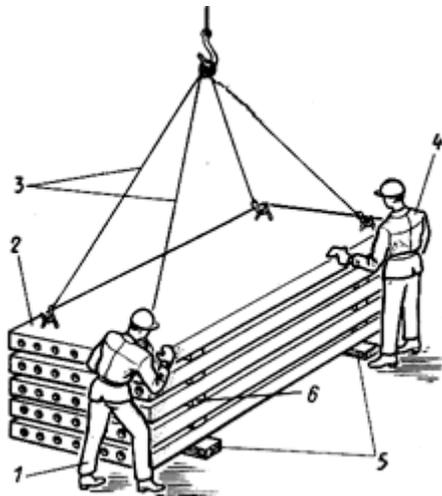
Укладка плит перекрытий в верхний ряд штабеля
